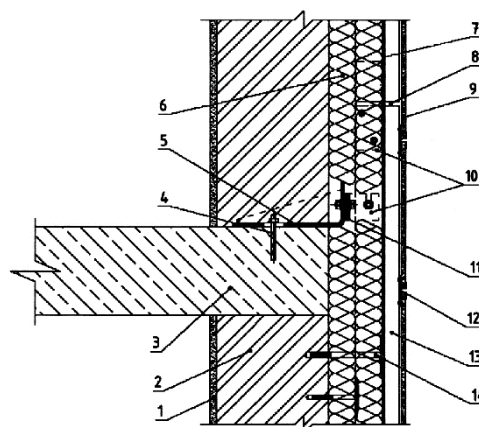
Конструктивна схема збірної системи із стояковим кріпленням зовнішнього опоряджувального захисного шару [1]:
